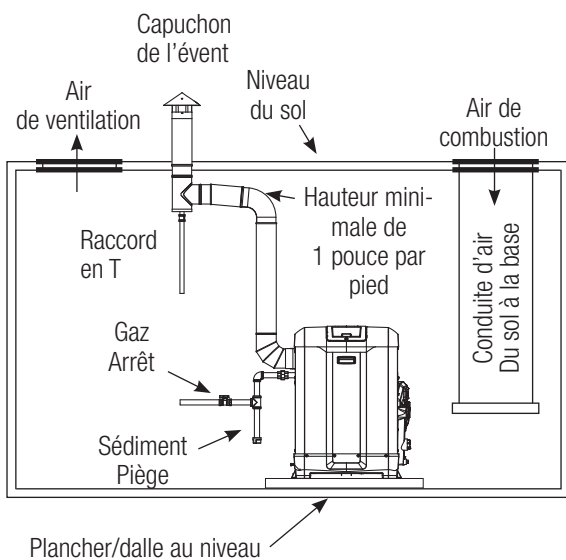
Installation avec air provenant de l'extérieur du bâtiment
